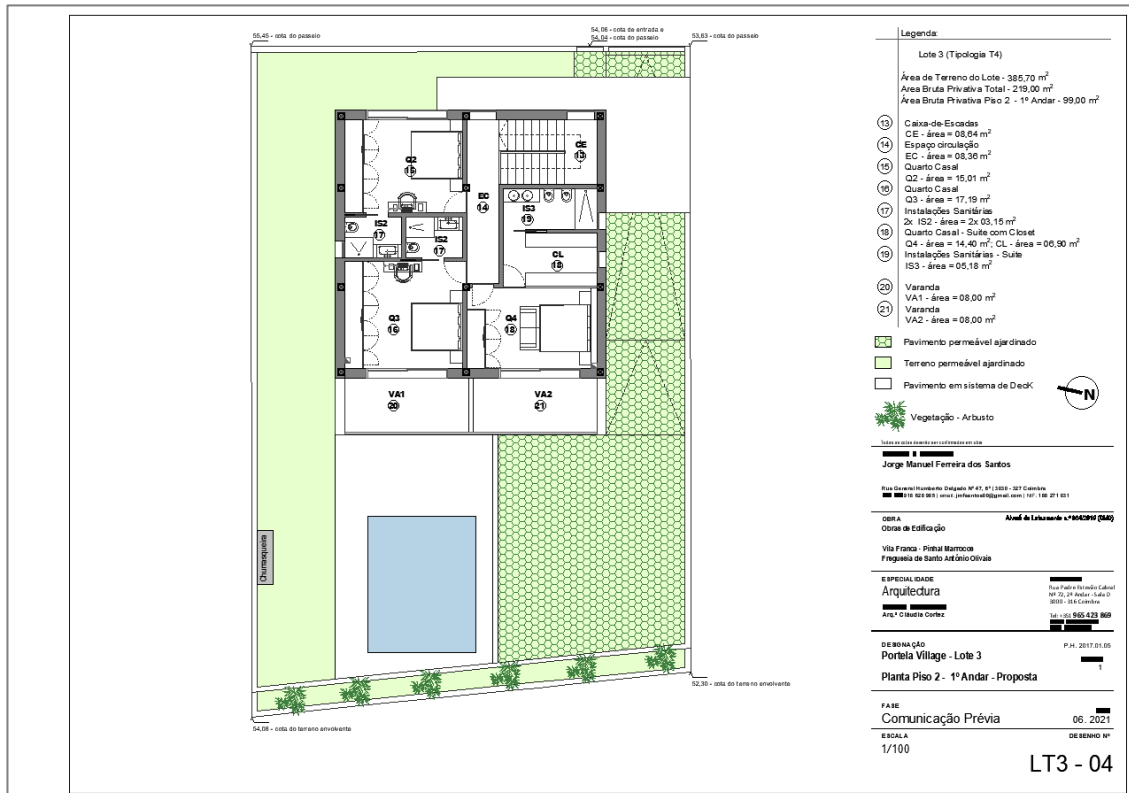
Planta baixa cedida pela construtora segundo pavimento - Projeto JH. Fonte: Acervo FBN
